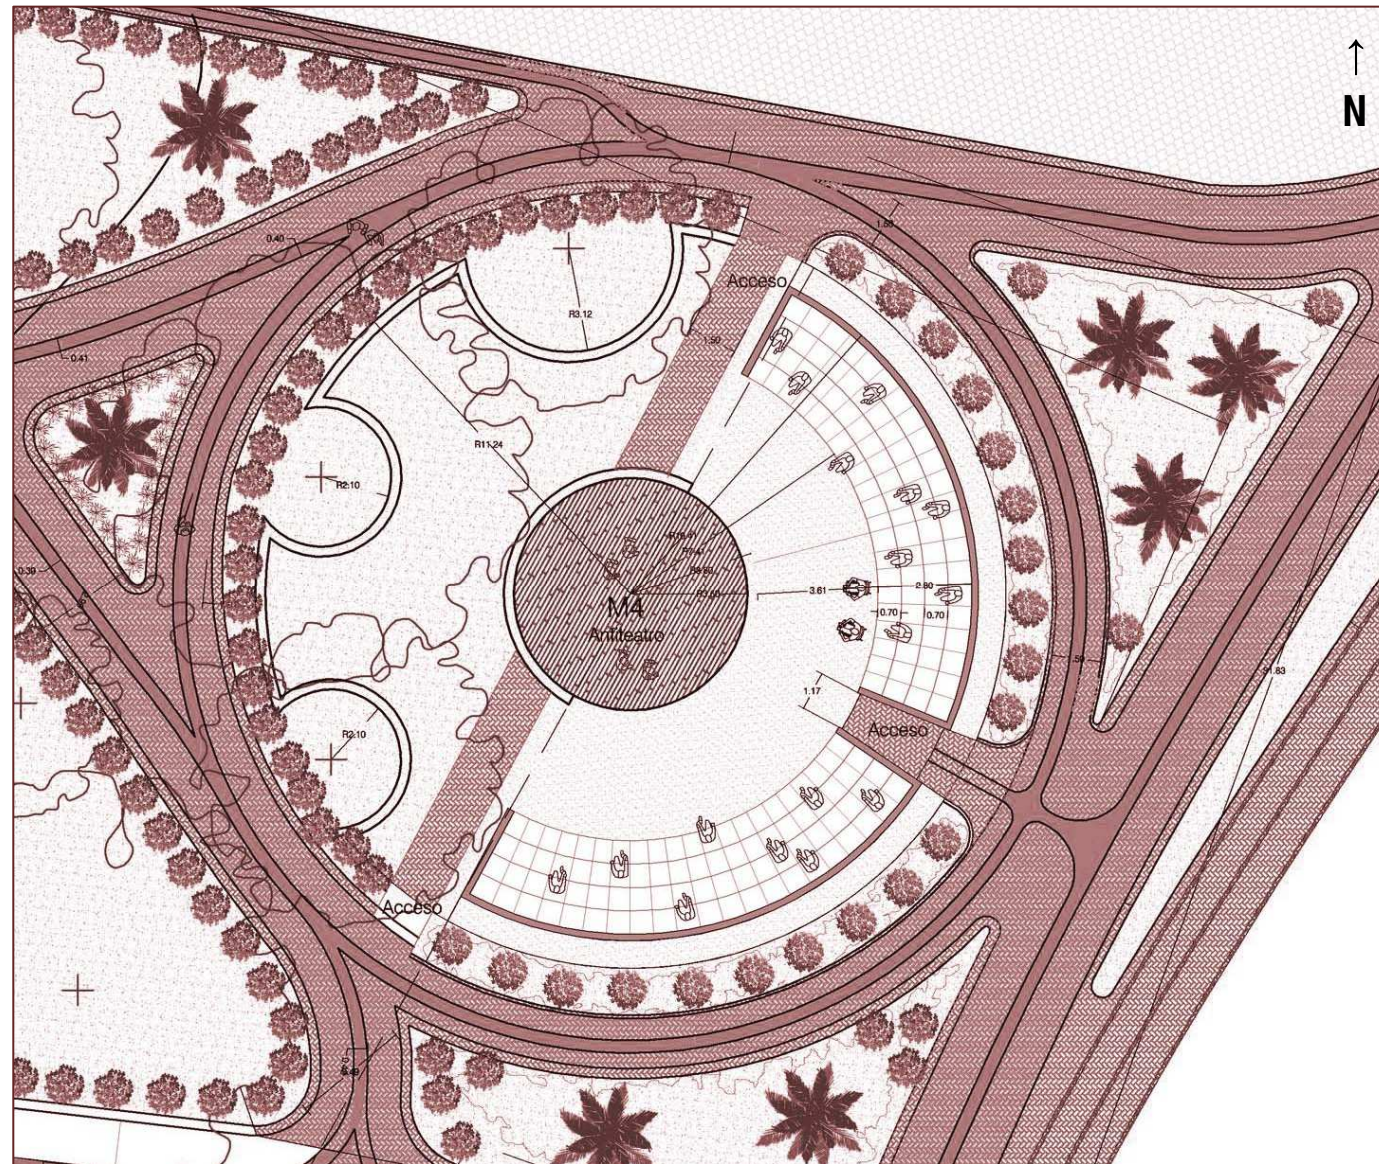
Módulo 4.Planta de distribución arquitectónica. Anfiteatro.
